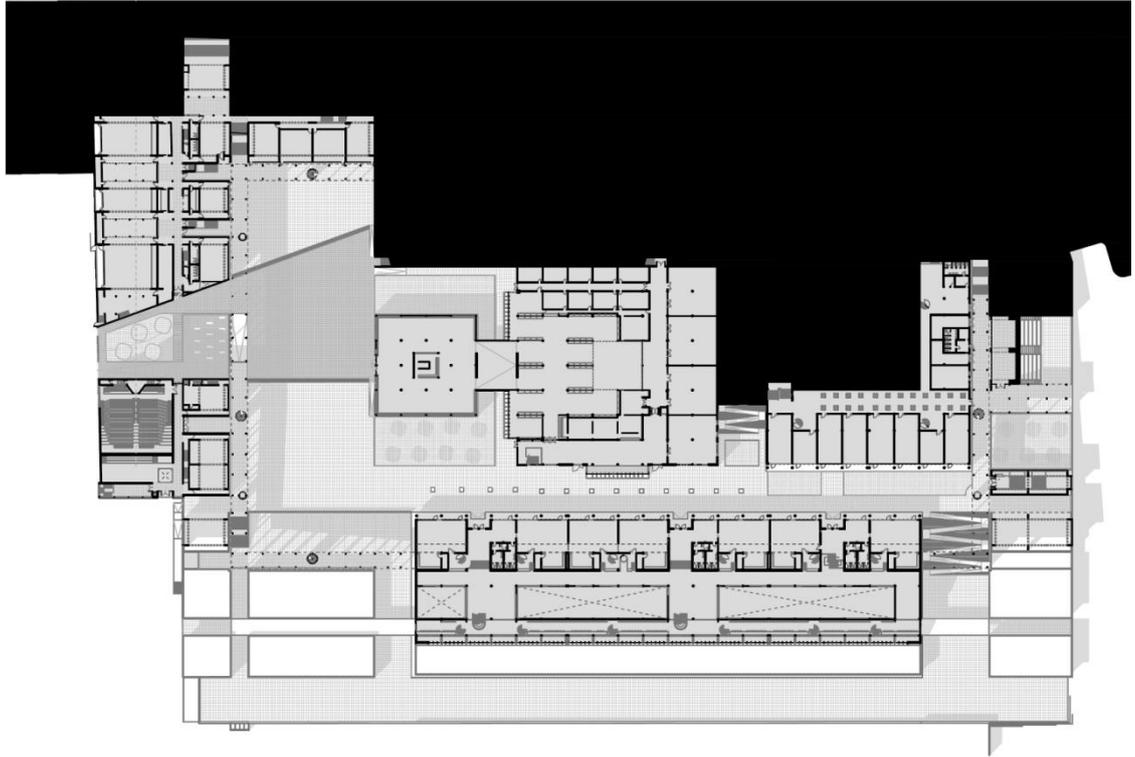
Planta do piso 0 da Faculdade de Arquitectura
